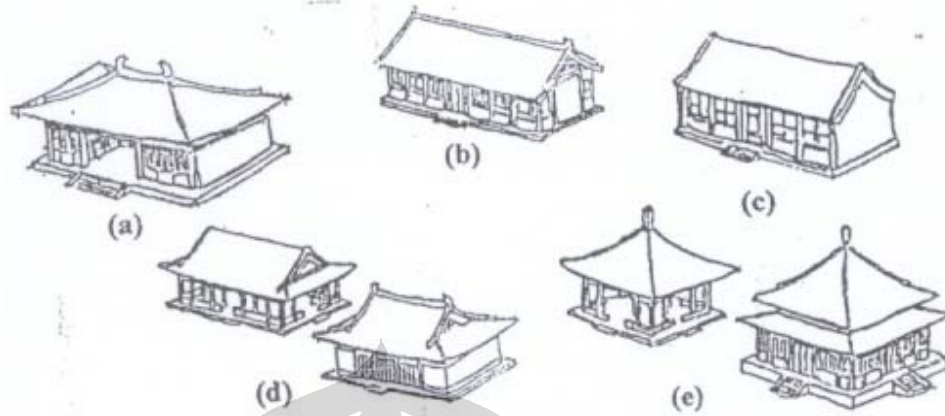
Denah bentuk ruang utama (Kohl, 1984: 89)
